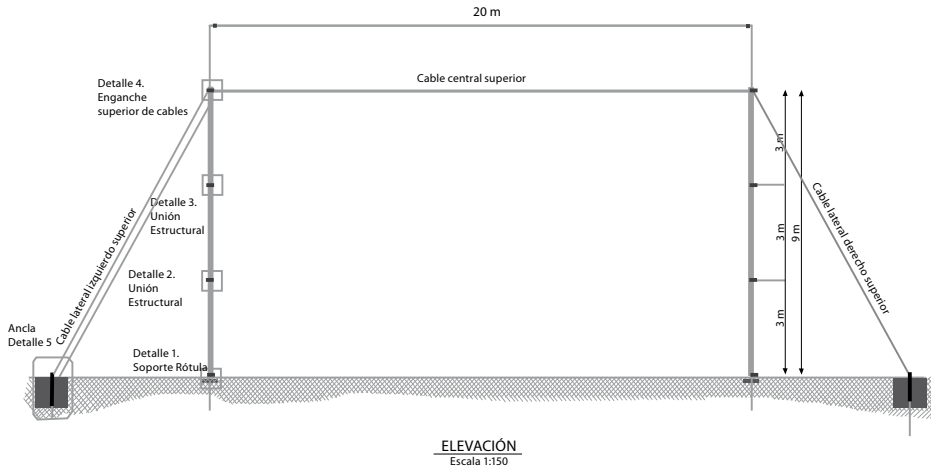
5: Levantamiento de atrapanieblas (Proyecto Atrapanieblas).
